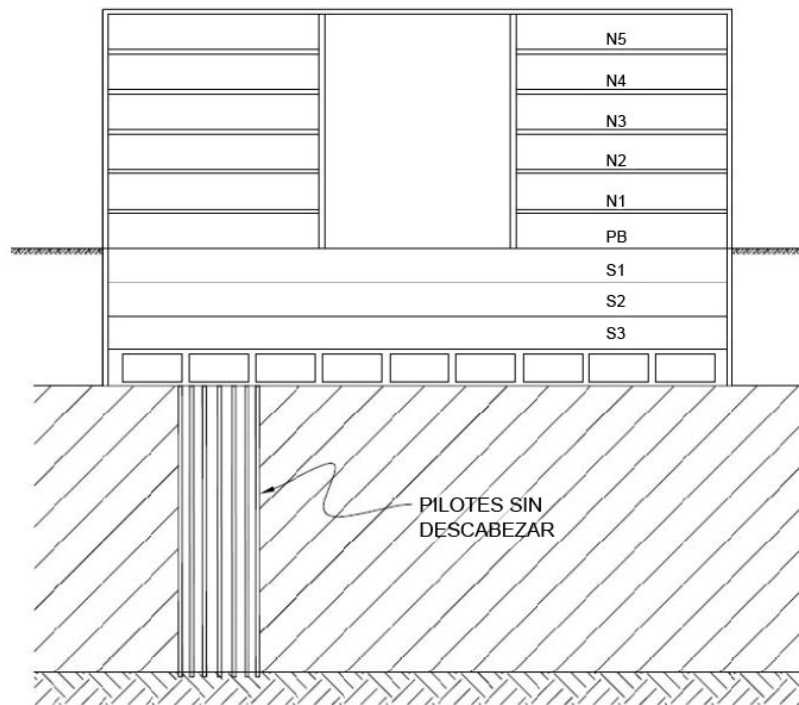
Corte longitudinal del Edificio de la CTM con vista de los pilotes sin descabezar.
